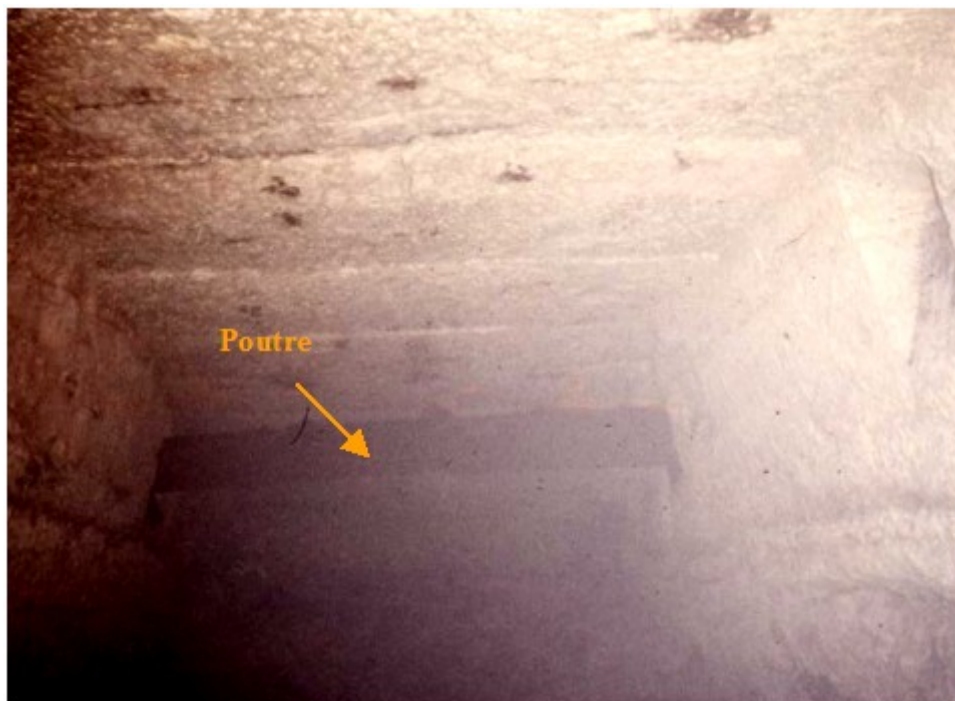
Poutre en place (portée de 3m) et traces parallèles de soulevage
